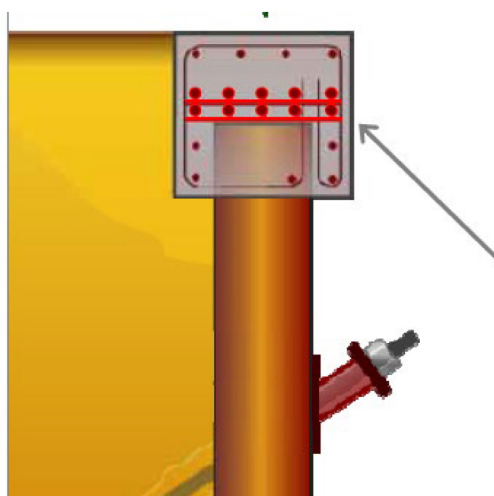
Вариант узла крепления плит покрытия к шпунтовым сваям
